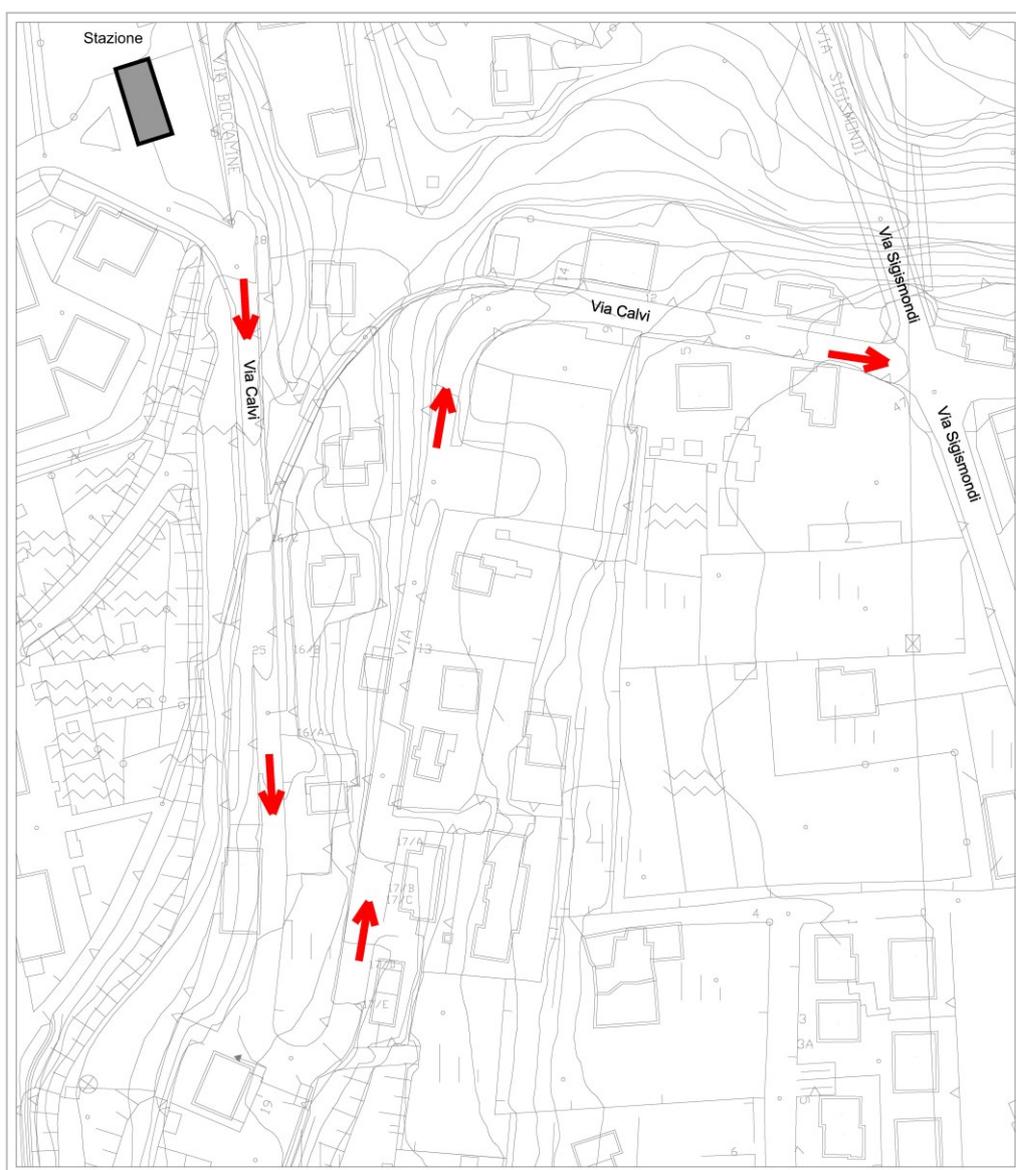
Assetto di Via Calvi di Progetto
